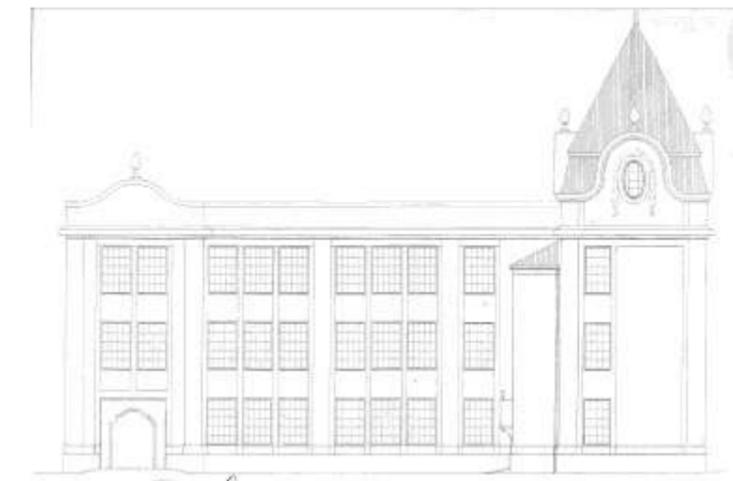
Das Webereigebäude Hofansicht – Einreichplan 1924
